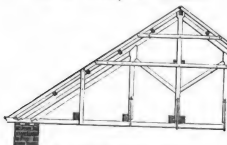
Dach mit fünf-fauligem Hängewerk.
